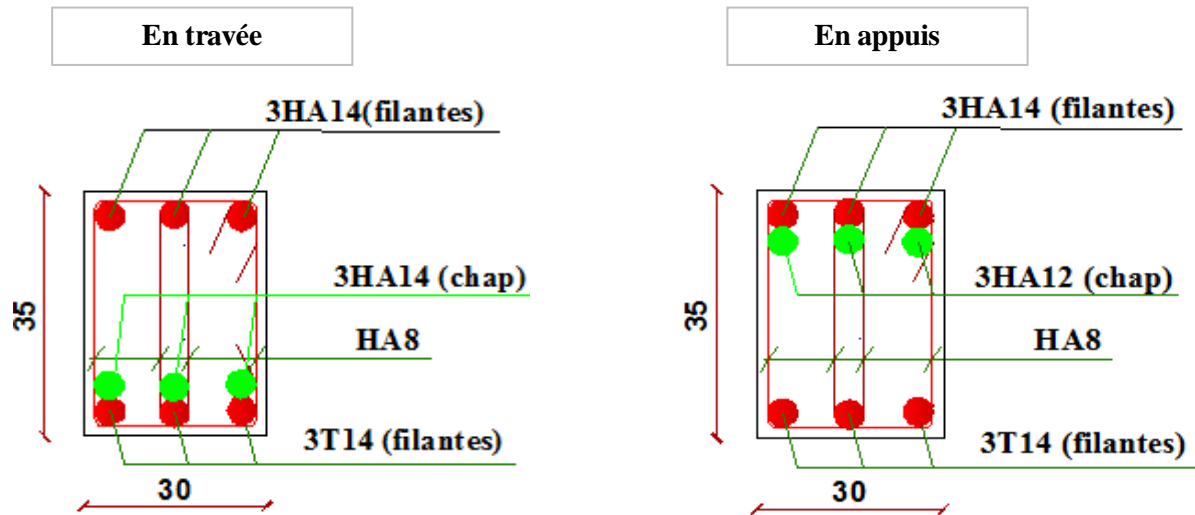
Ferrailage des poutres principales de la structure mixte
